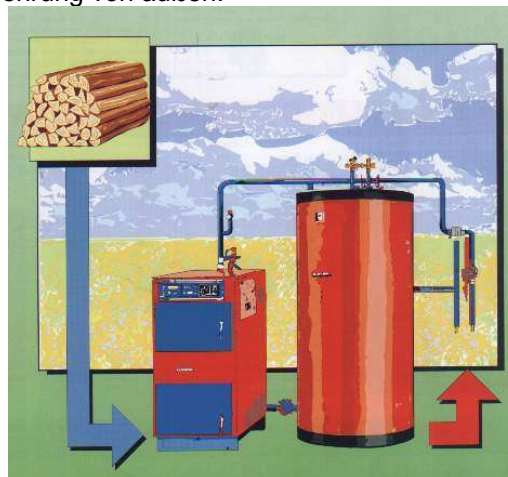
Scheitholzanlage zur Holzvergassung mit Wärmespeicher
